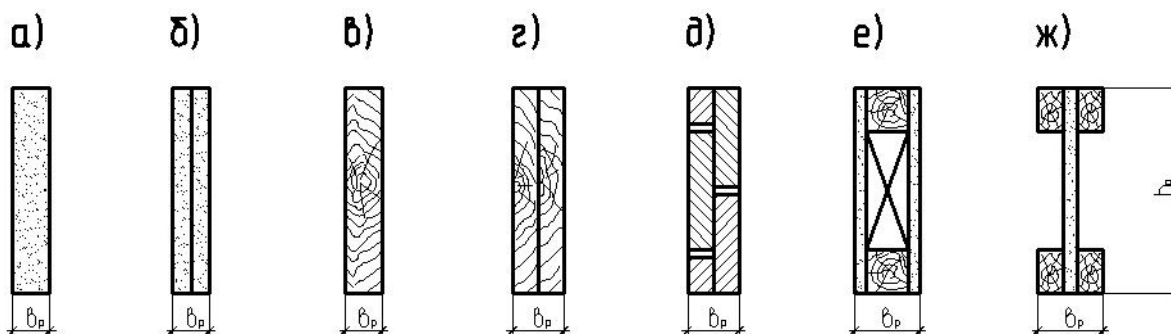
Рекомендуемые типы несущих ребер для панелей перекрытия:
